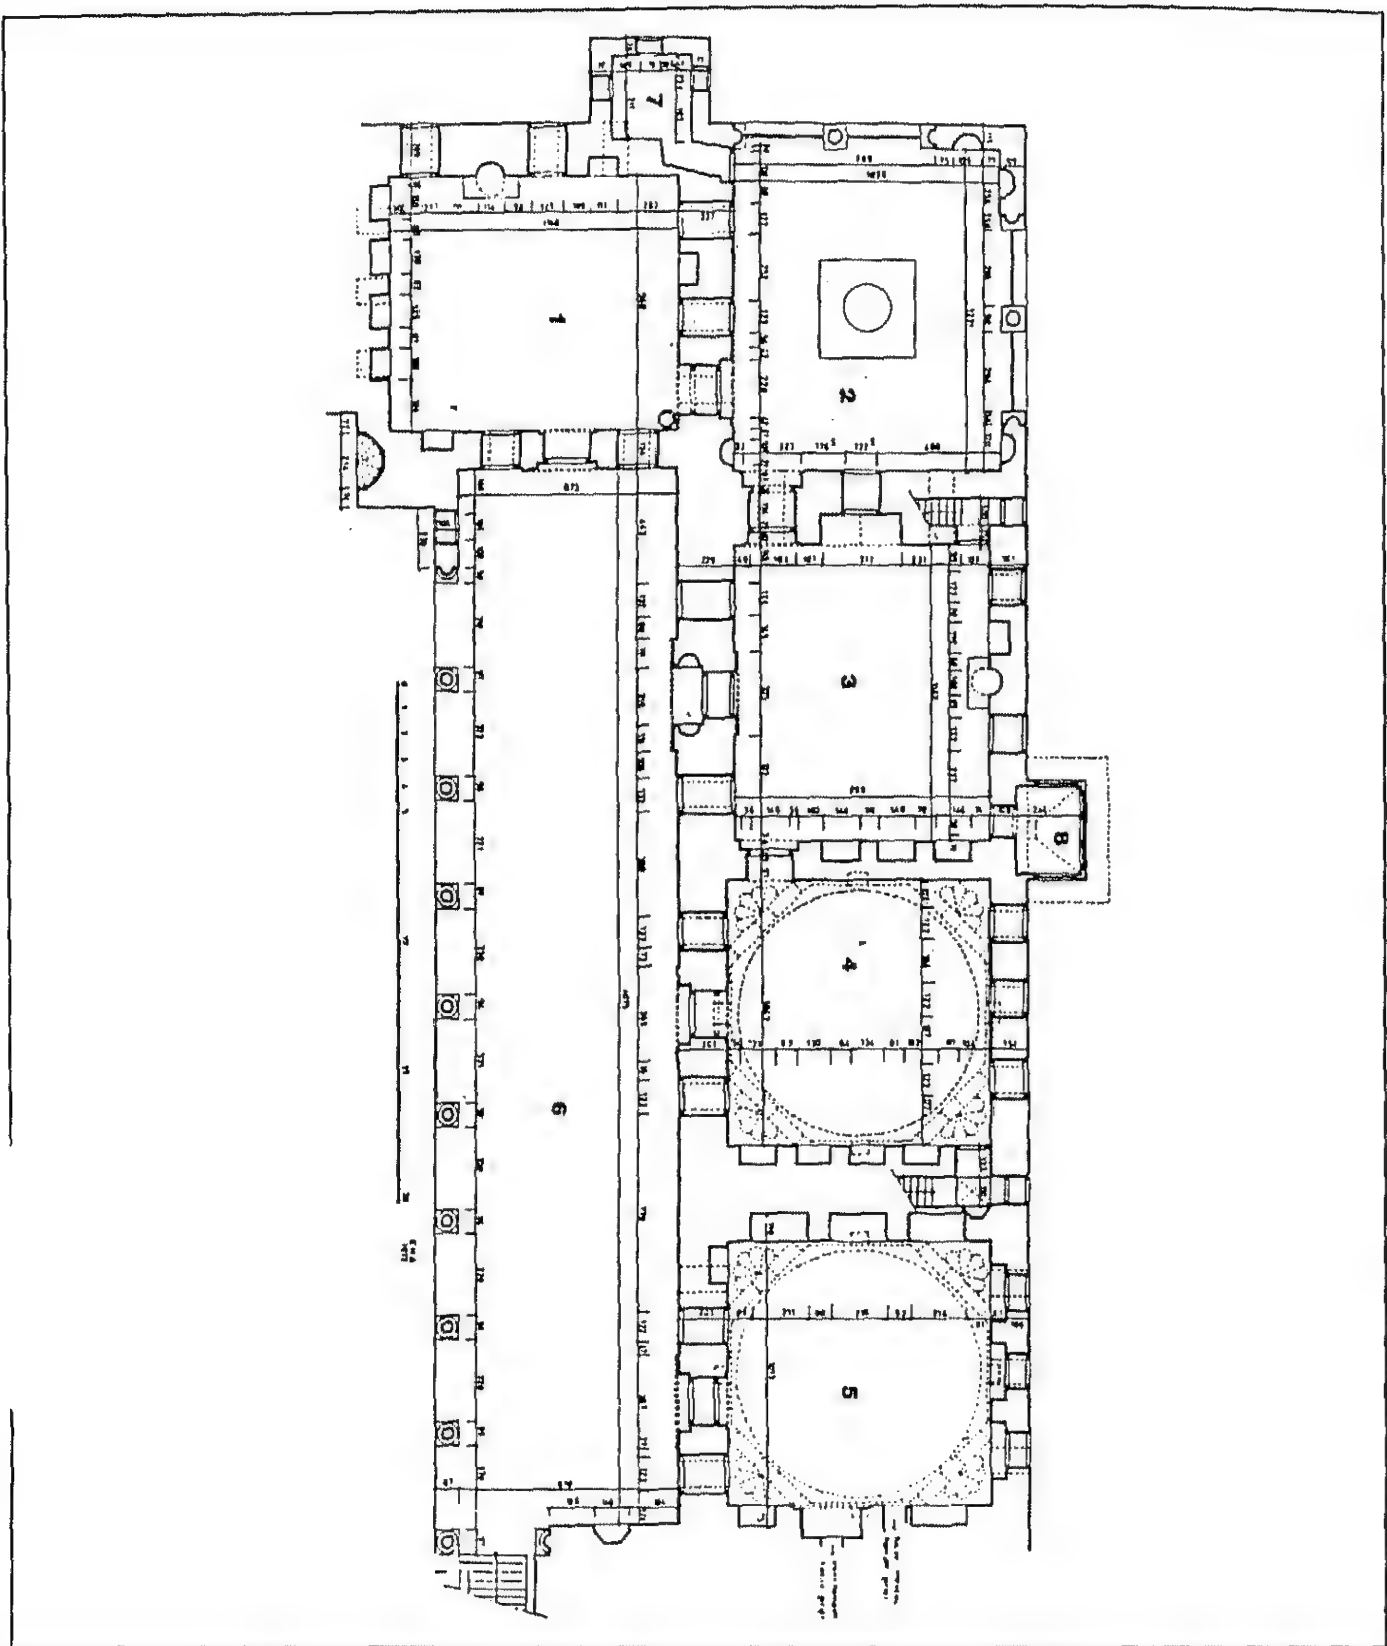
مسقط أفقي لطوب قابي سراي بإستانبول (عن : افيا بان) .
